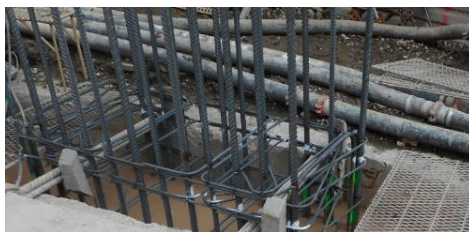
Colocación de jaulas de concreto en la zanja.⁷
